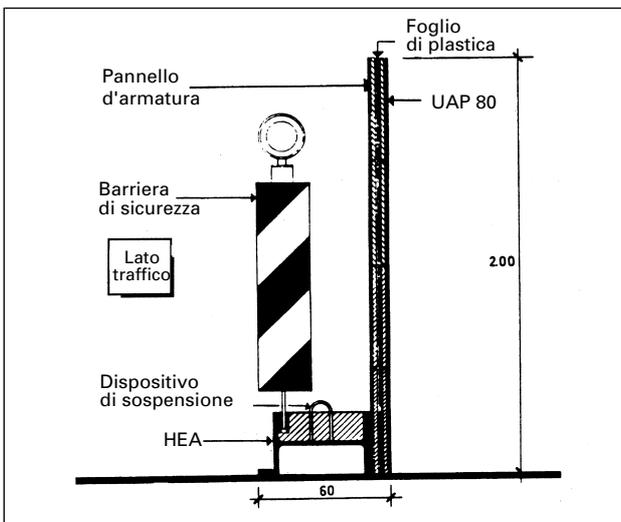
parete di protezione semplice munita di una barriera di sicurezza
